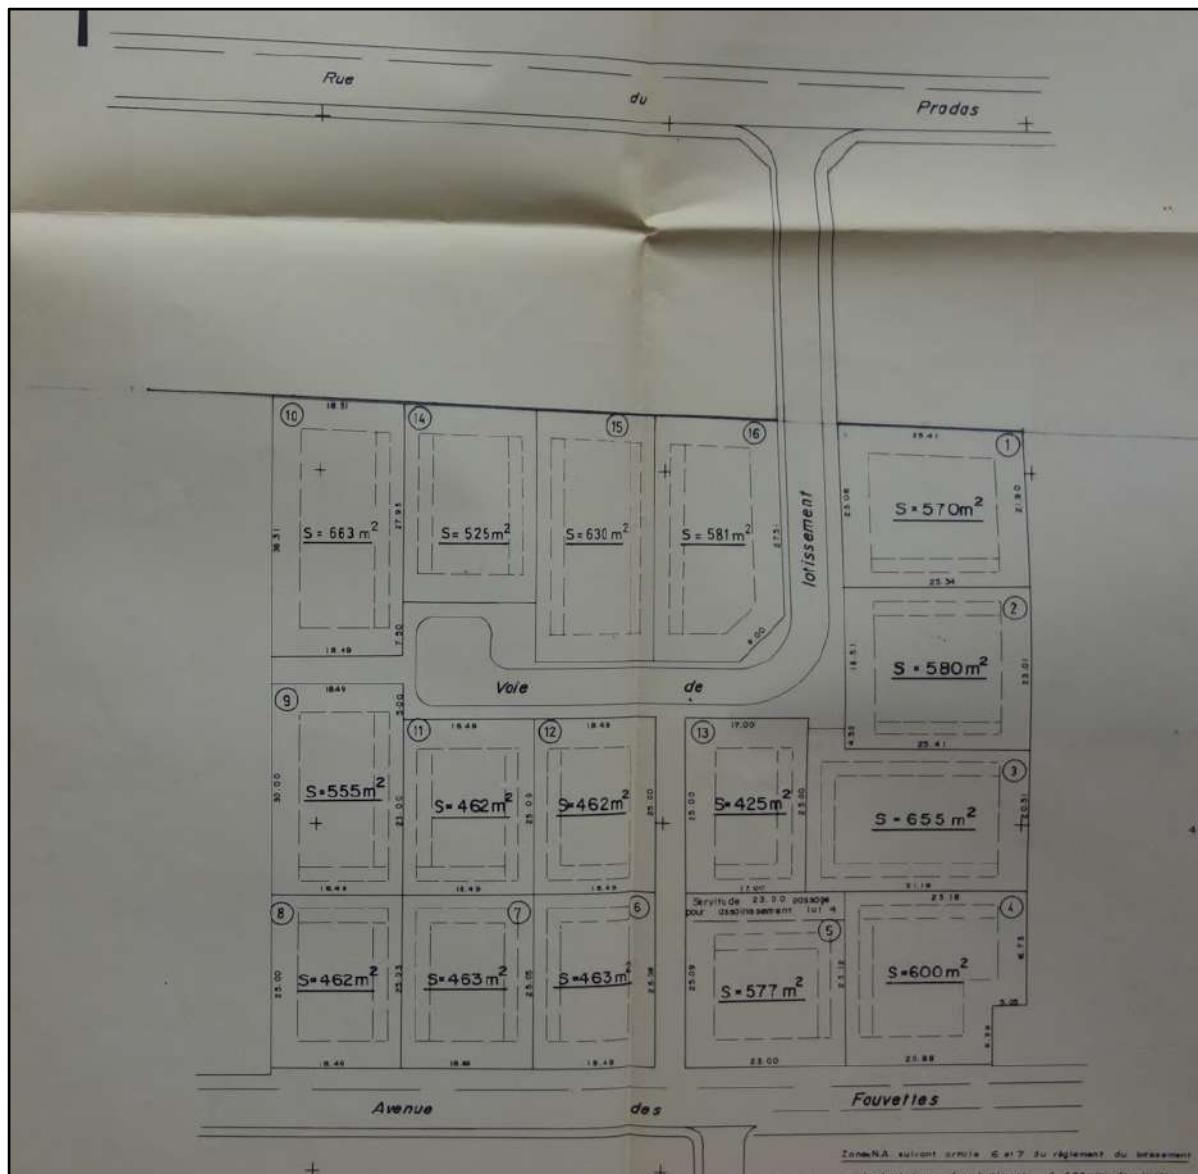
Plan de l'ensemble pavillonnaire "Vivaldi" entre l'avenue des Fauvettes et la rue du Pradas (Source : AM Mérignac - 661w35).
